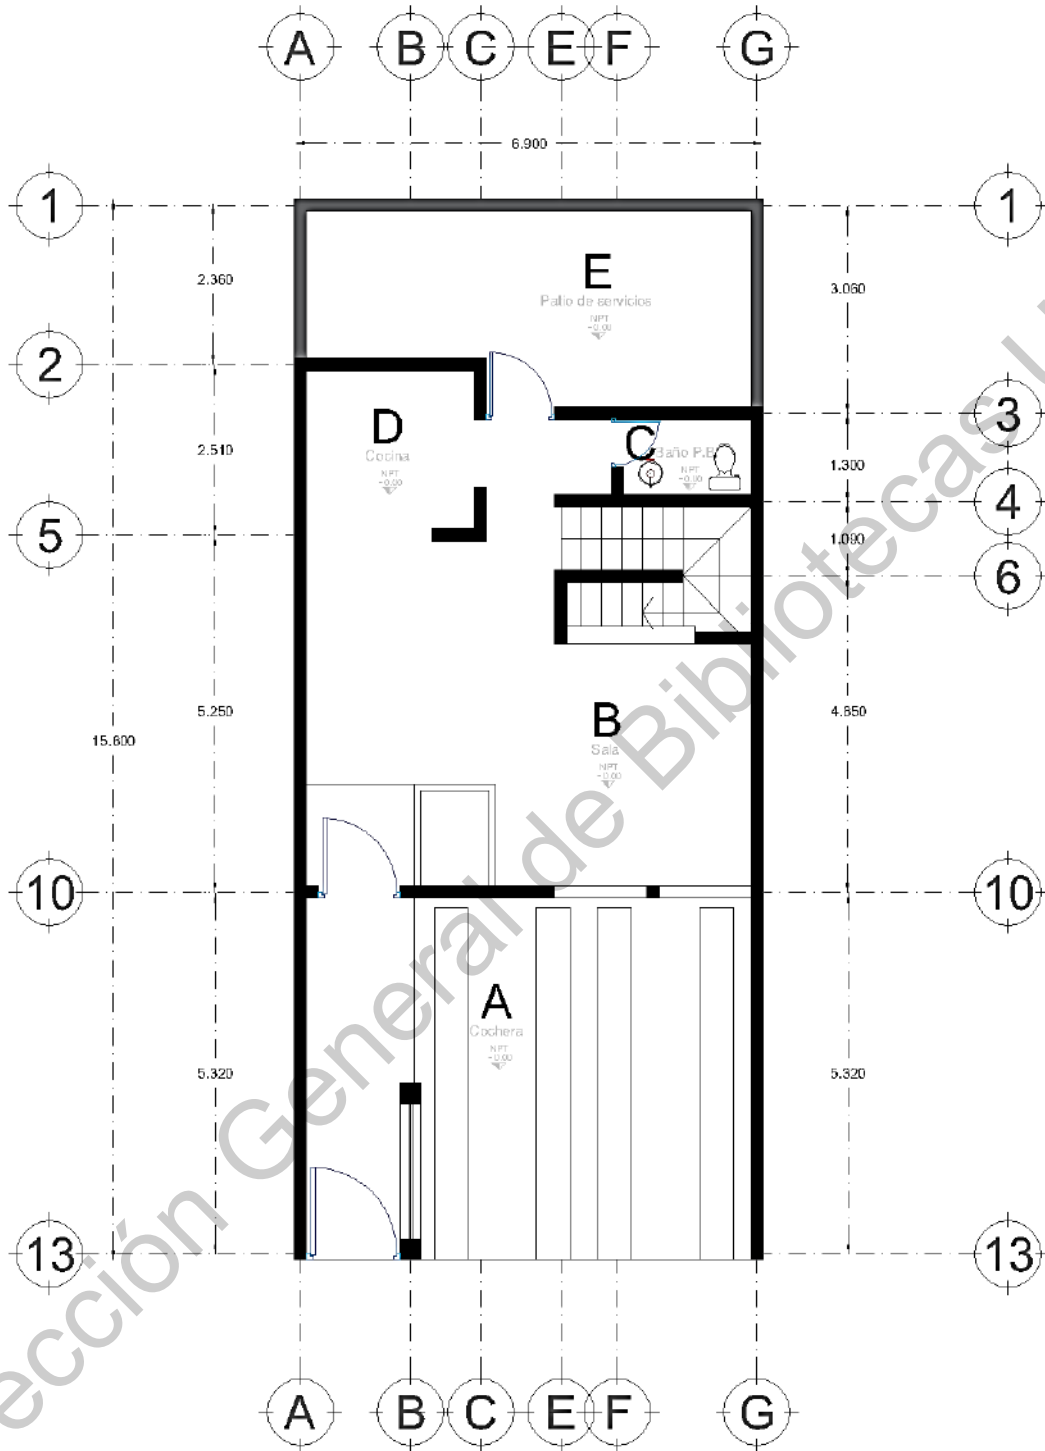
Planta Arquitectónica Baja. Casa Ixtlán
